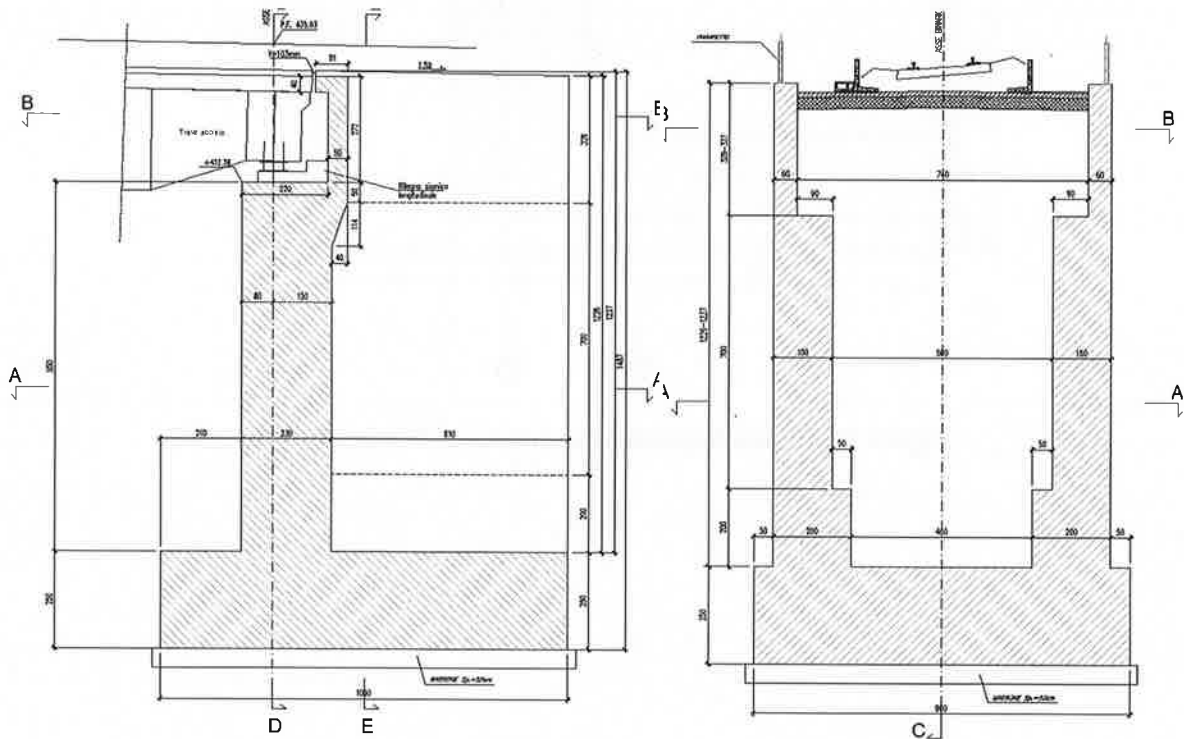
Sezione longitudinale e trasversale spalla B Bonorva VI01
